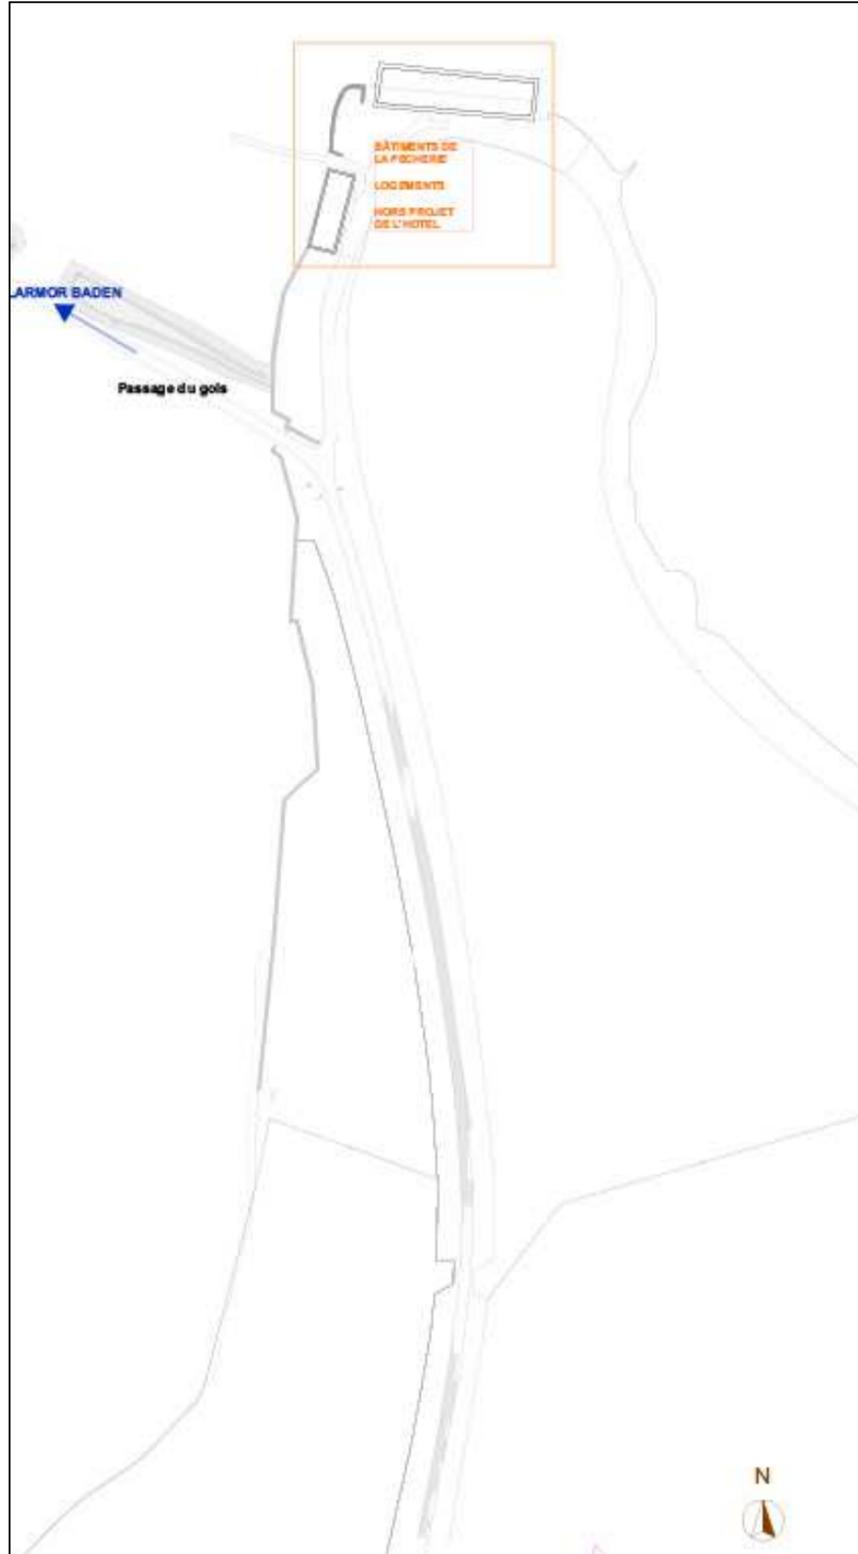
Plan masse du projet (Source : Paumier Architectes Associés)
